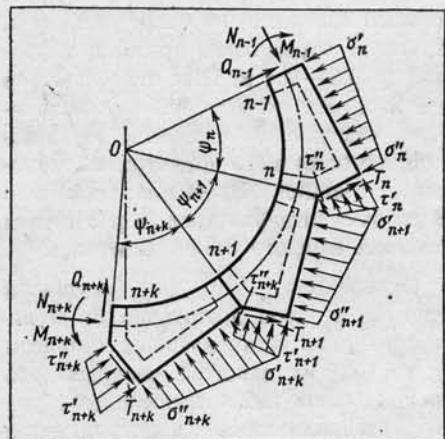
Расчетная схема опорной стены с наружными опорными выступами.
